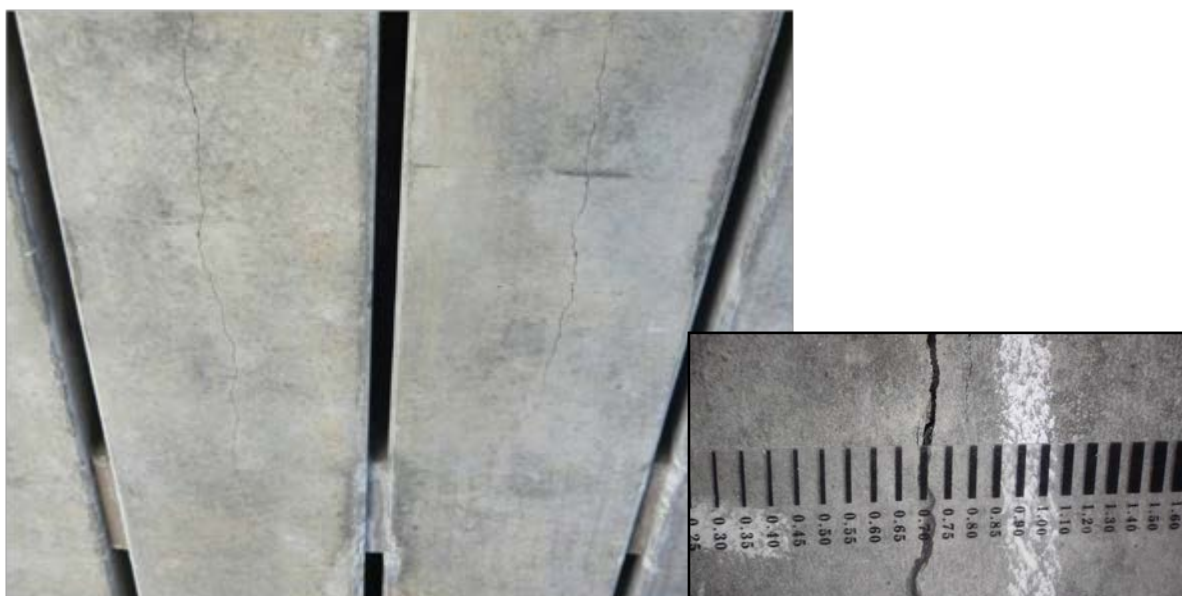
ASRによる橋軸方向のひび割れ例【PCプレテン中空床版橋（ホロー形式）】
